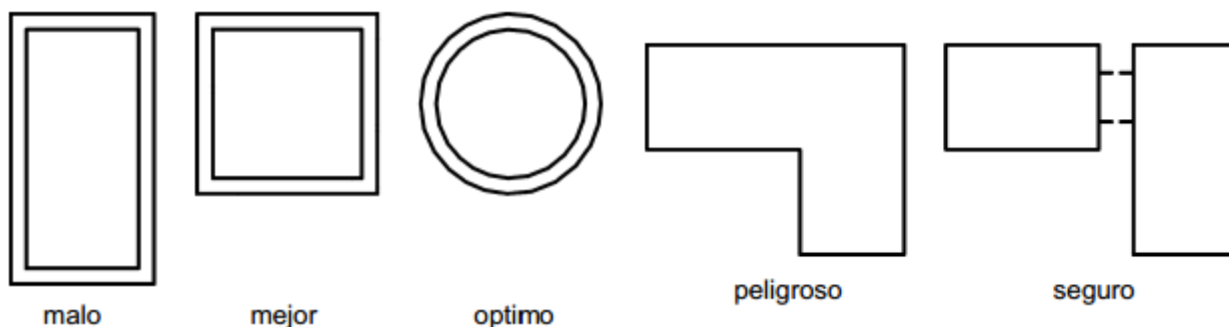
Geometría de plantas adecuadas para construcciones antisísmicas
